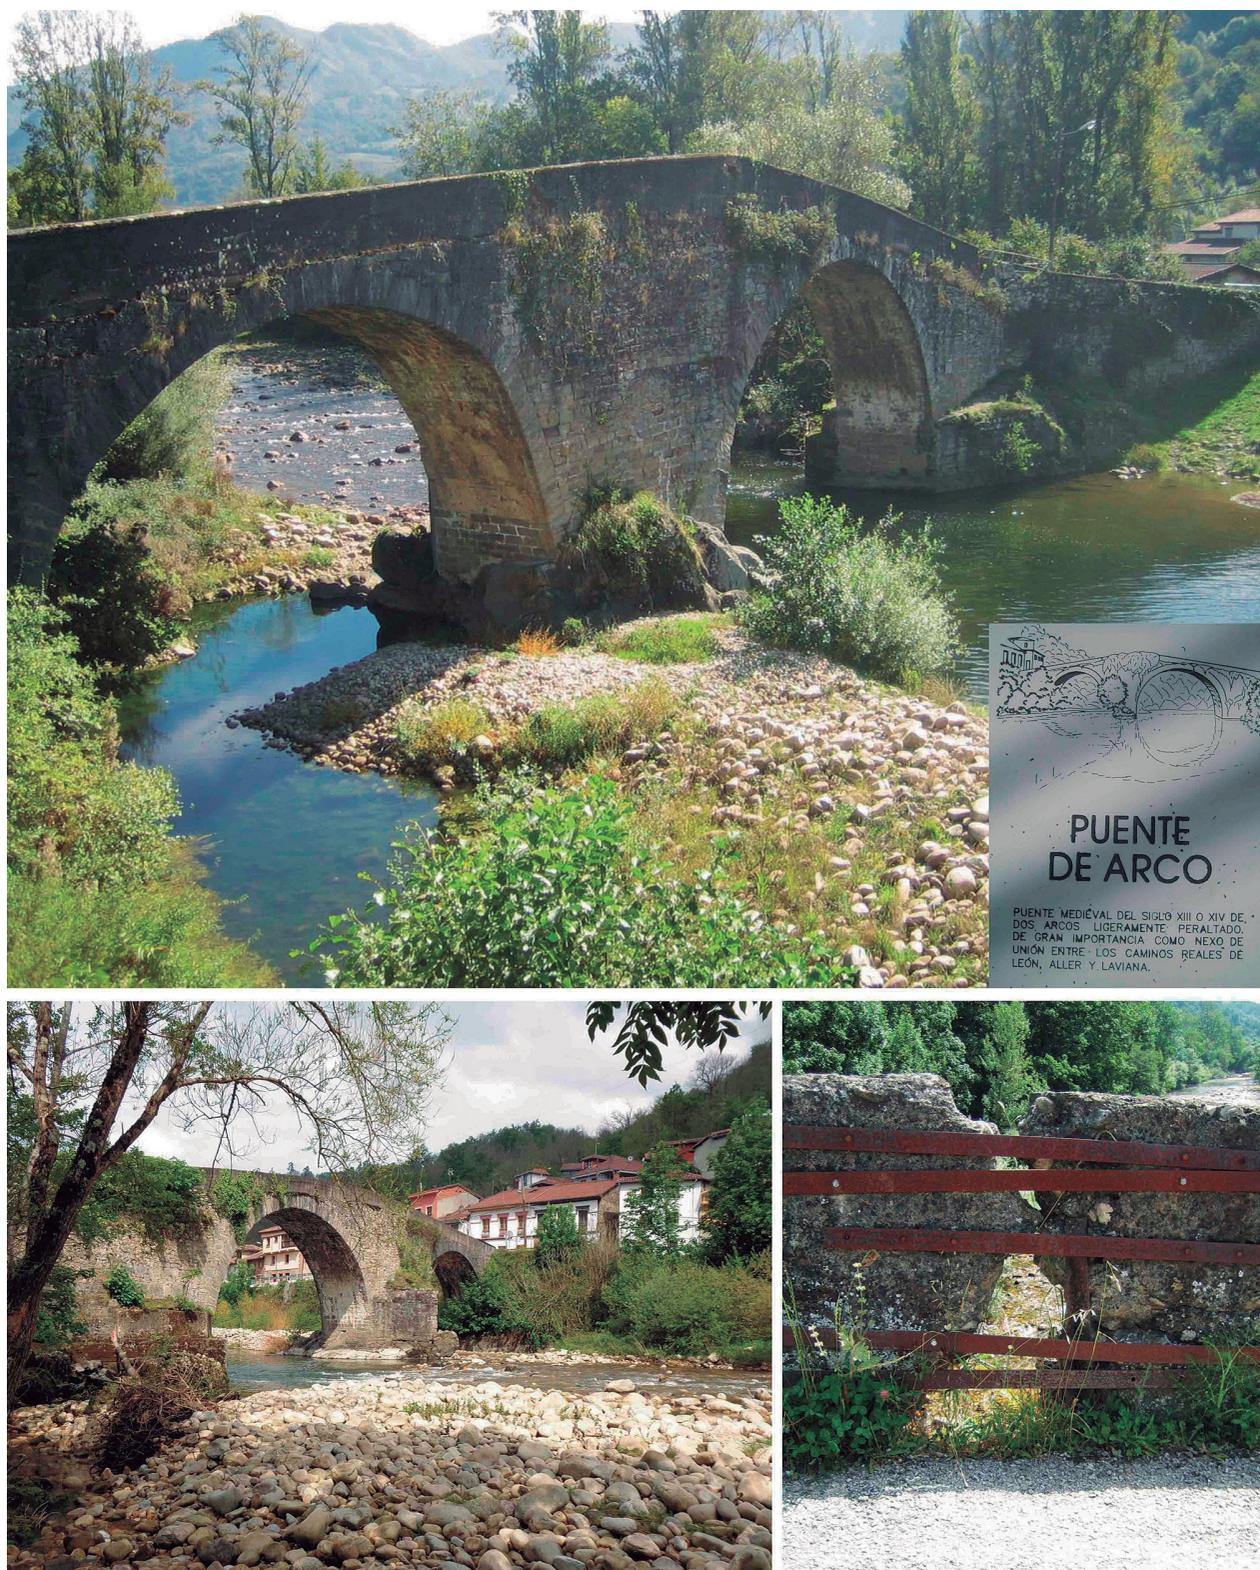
Vistas generales del puente antes de su restauración (aguas abajo y aguas arriba) en las que se pueden apreciar los pretiles de hormigón, la cimentación de la pila central (capaz de soportar la carga proveniente de la superestructura), las características del tajamar, muy enraizado, y la rampa comprometida de acceso al río. En los recuadros: detalle del estado previo de uno de los pretiles (este), con fracturas y lañas metálicas encadenadoras; también, punto de vista, en formato de señalización, que considera a la infraestructura como medieval (autores) / General views of the bridge before its restoration (downstream and upstream) in which you can see the concrete parapets, the foundation of the central pier (capable of supporting the load coming from the superstructure), the characteristics of the cutwater, very rooted, and the compromising access ramp to the river. In the boxes: detail of the previous state of one of the parapets (east), with fractures and metal chaining rods; also, point of view, in signage format, which considers the infrastructure as medieval (authors).
